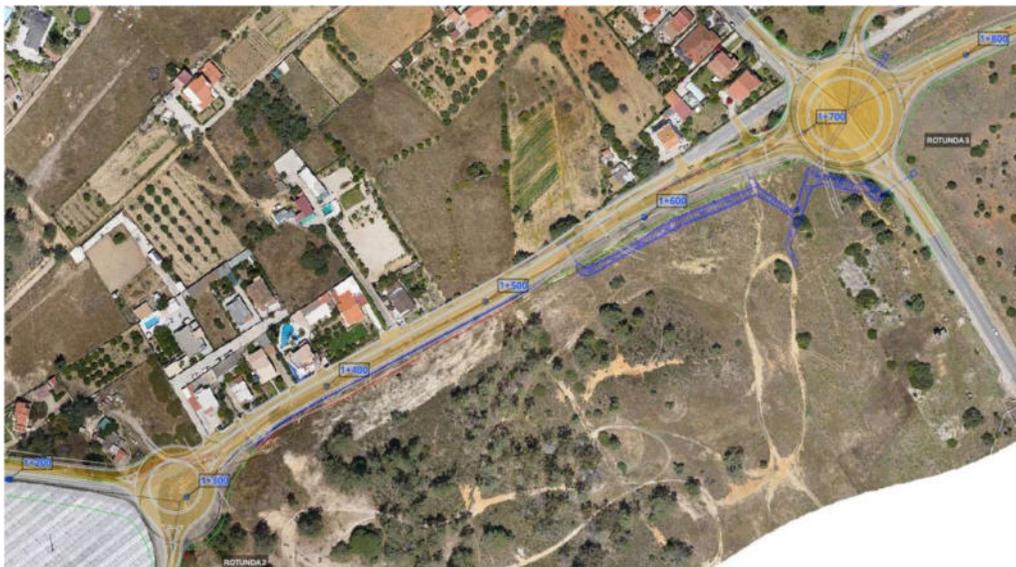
Troço entre a Rotunda 2 (ex-Rotunda B1) e a Rotunda 3 (ex-Rotunda B2)
